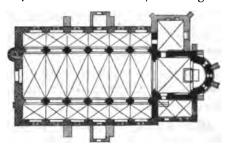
Altenkirchen. Kirche. Grundriss. 1:667.
